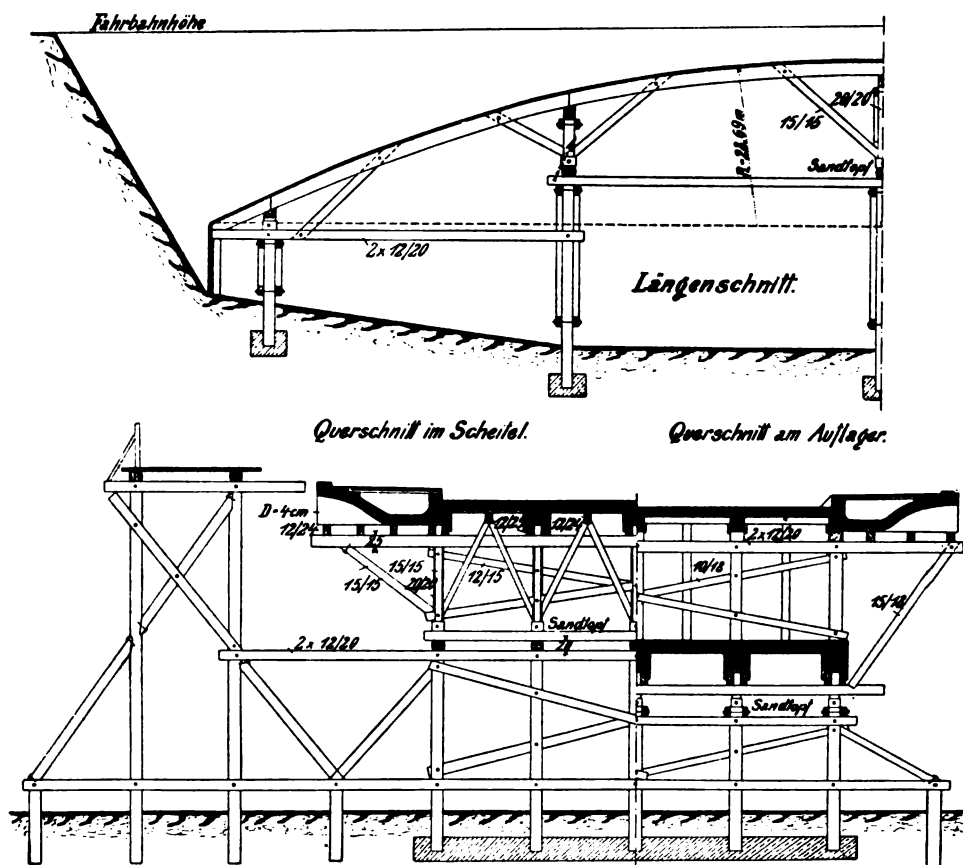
Lehrgerüst der Sillbrücke bei Innsbruck.
